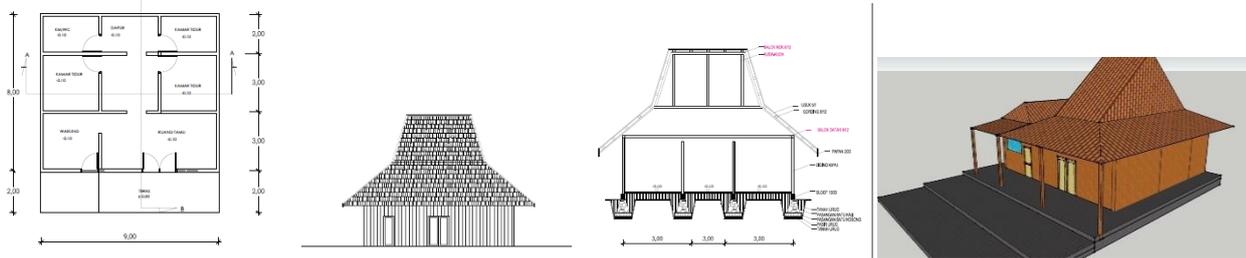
Denah, Tampak dan Potongan Rumah Keempat
